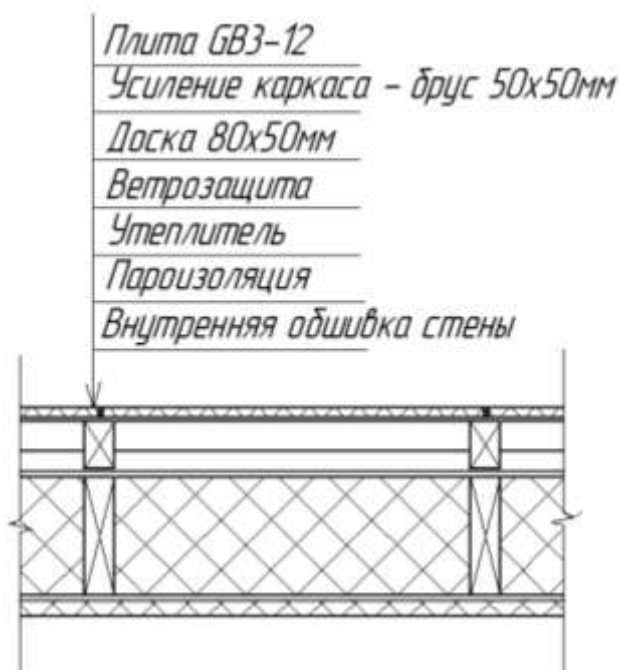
Разрез стены по горизонтали с вентилируемым фасадом без швов на основе плит GREEN BOARD® высокой плотности без покрытия
